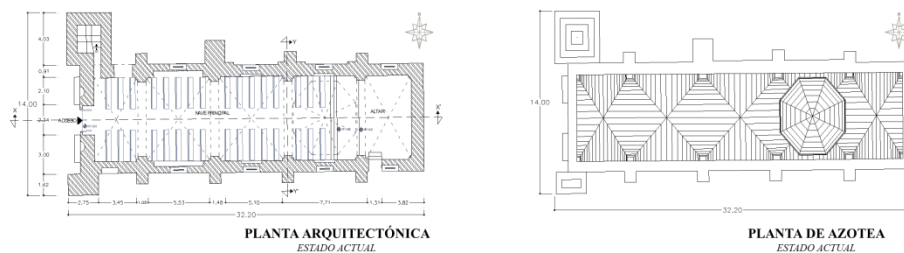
Planta arquitectónica y de azoteas de la parroquia de San Bernardino, estado actual. (Espinosa M. 2018)
